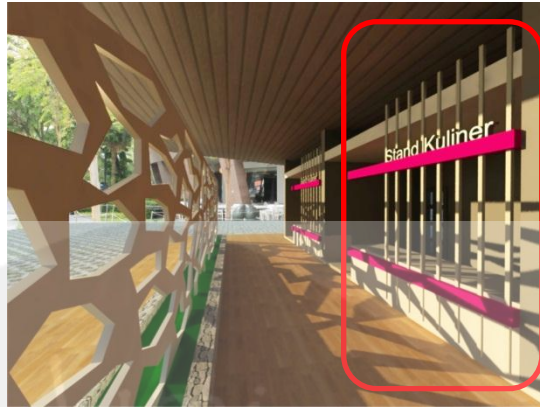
Penjelasan aplikasi Struktur dalam bangunan
